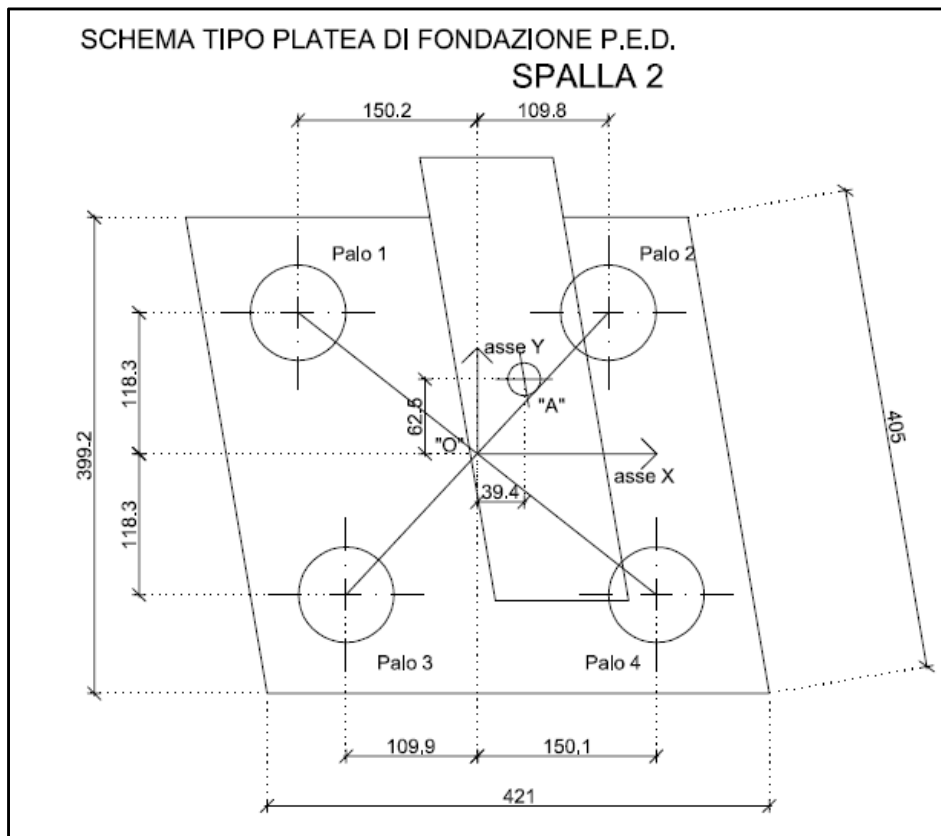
schema tipo calcolo platea/pali di fondazione P.E.D. (piedritto/spalla 2)
